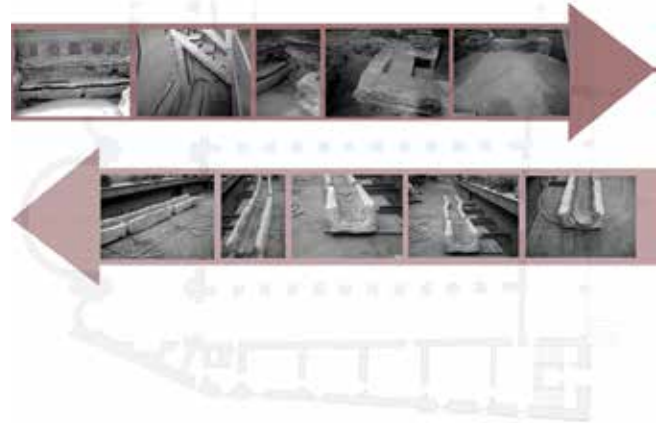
Fasi di demolizione della pavimentazione preesistente con gli elementi architettonici rinvenuti
